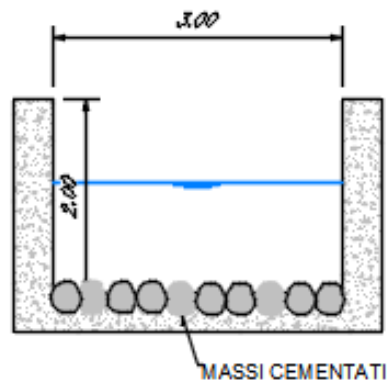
Corso d'acqua NI04_Sezione tipo sistemazione
